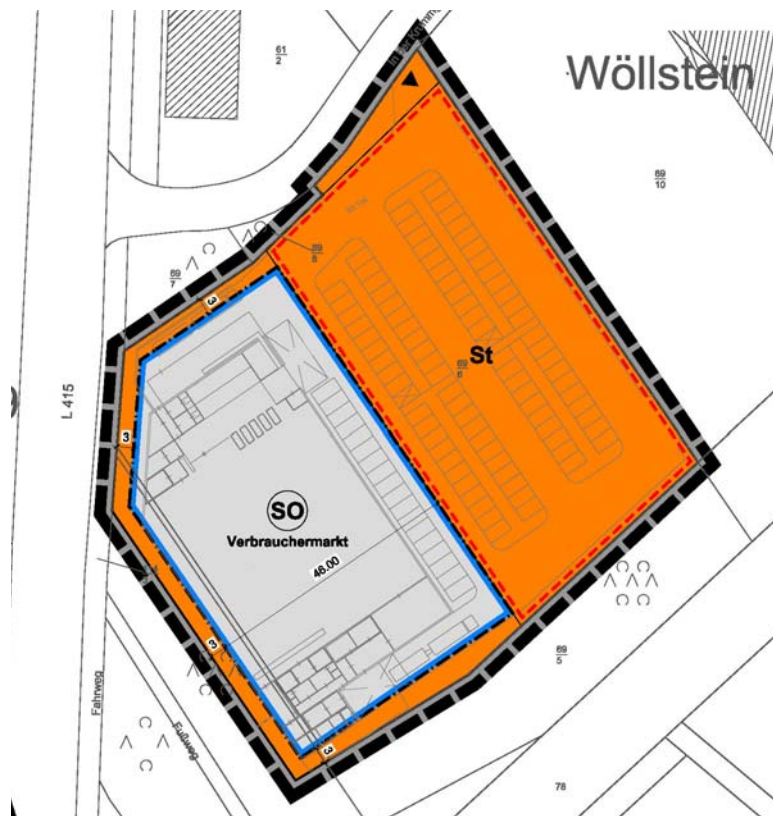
Bebauungsplanausschnitt „In der Krümmgewann“ 3. Teiländerung und Erweiterung, ohne Maßstab.
